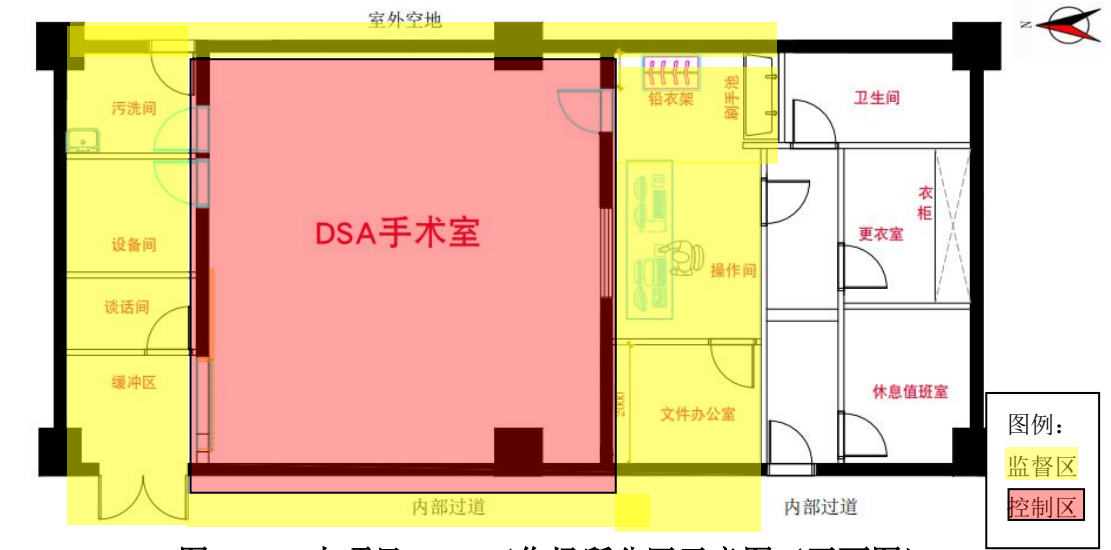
本项目 DSA 工作场所分区示意图（平面图）
